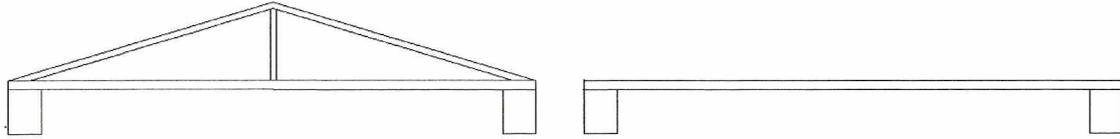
Cubierta estable o plana con viga cumbre o de soporte
